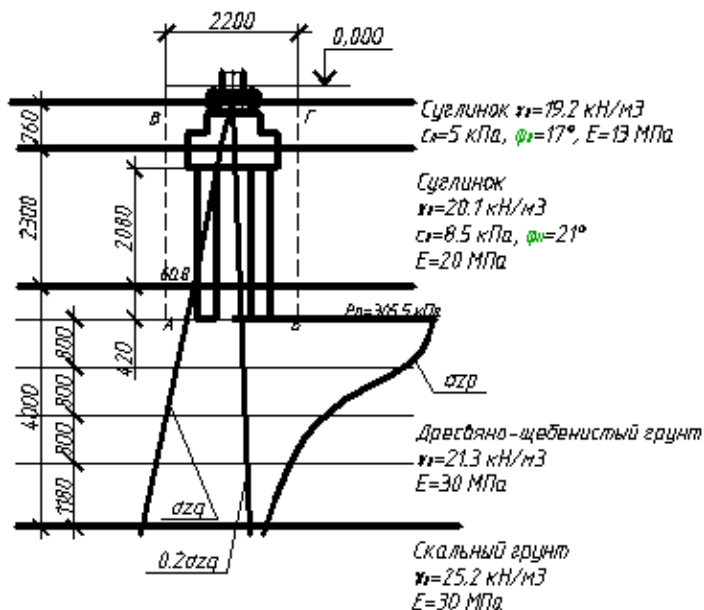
Схема к определению осадок фундамента «2»/«В»
